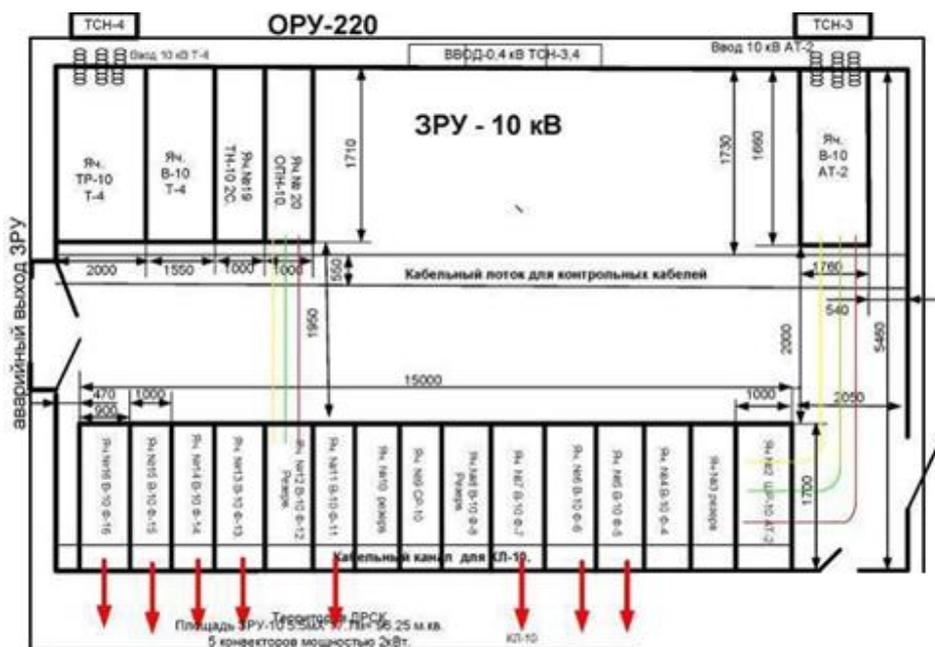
План существующего помещения ЗРУ-10 кВ
